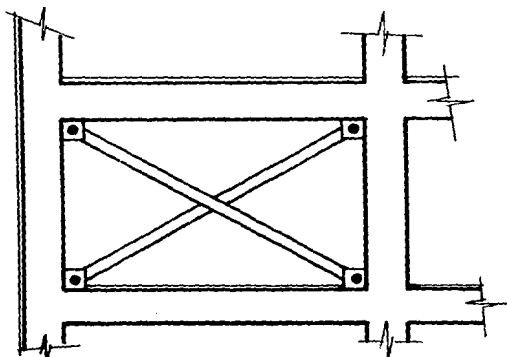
CONTRAVENTEO SIMPLE CON PERFILES DE ACERO
